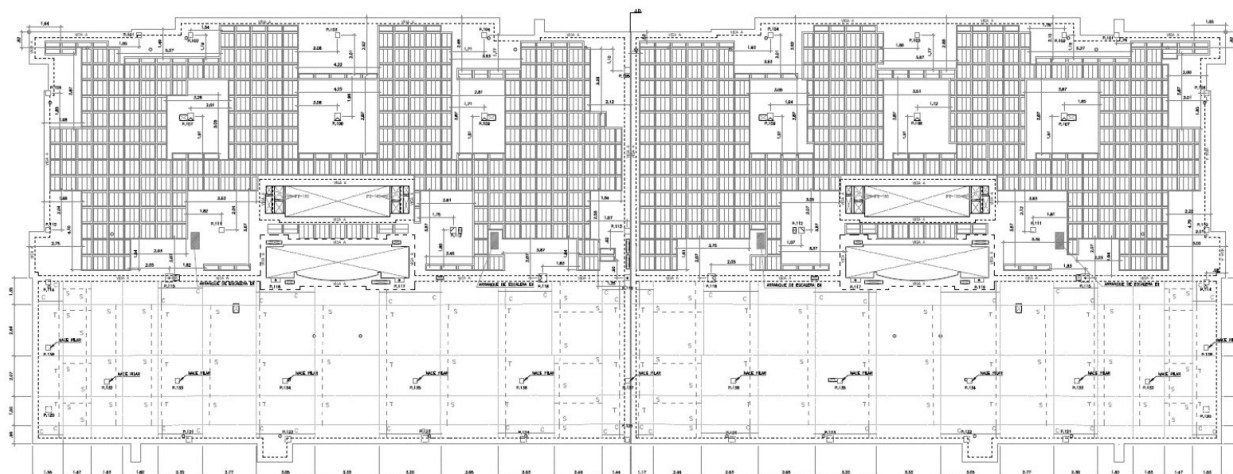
Planta tipo sobre rasante de uno de los edificios.
